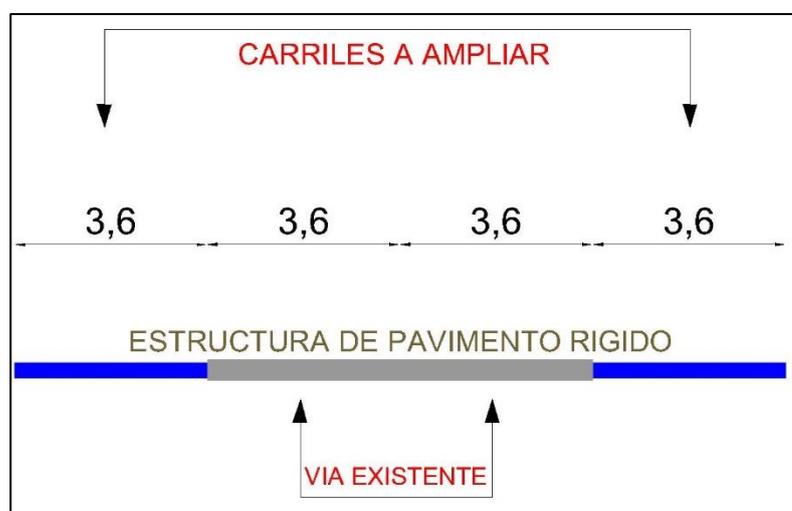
Esquema preliminar de ampliación de vía con pavimento rígido.
